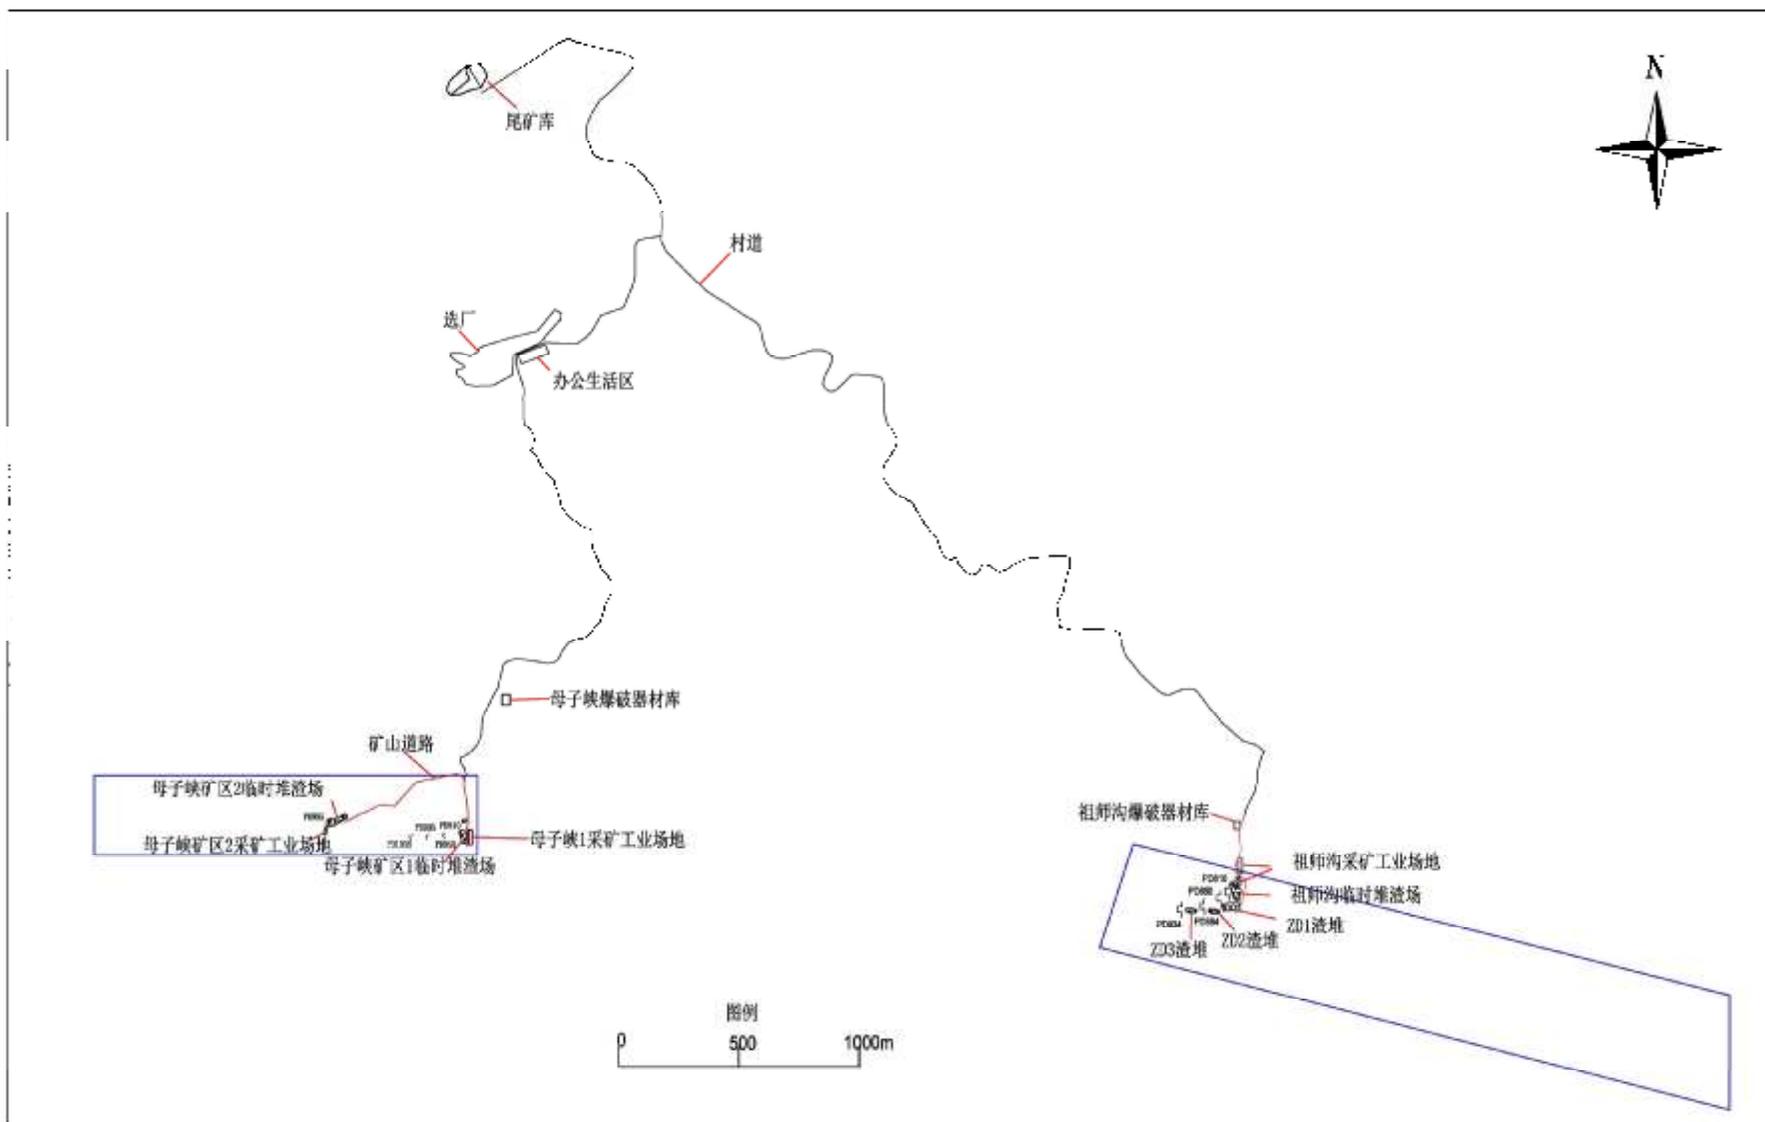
丹凤豪盛钒矿矿山工程平面布置示意图
